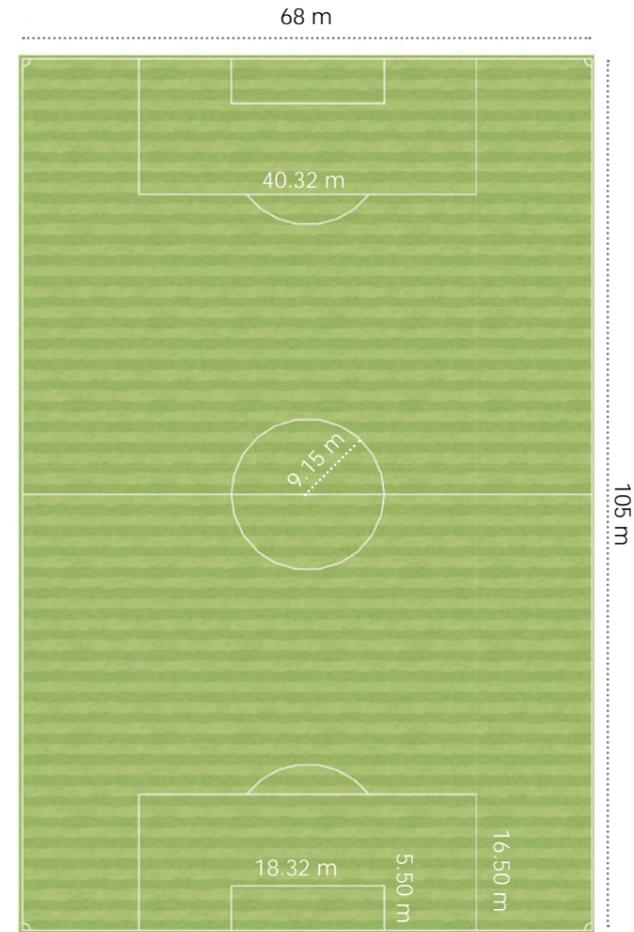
Planta de campo de juego. Fuente: Elaboración propia.
